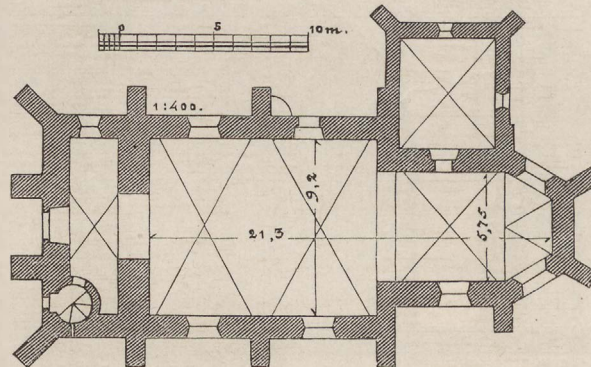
Waldau. Grundriss der Kirche.
